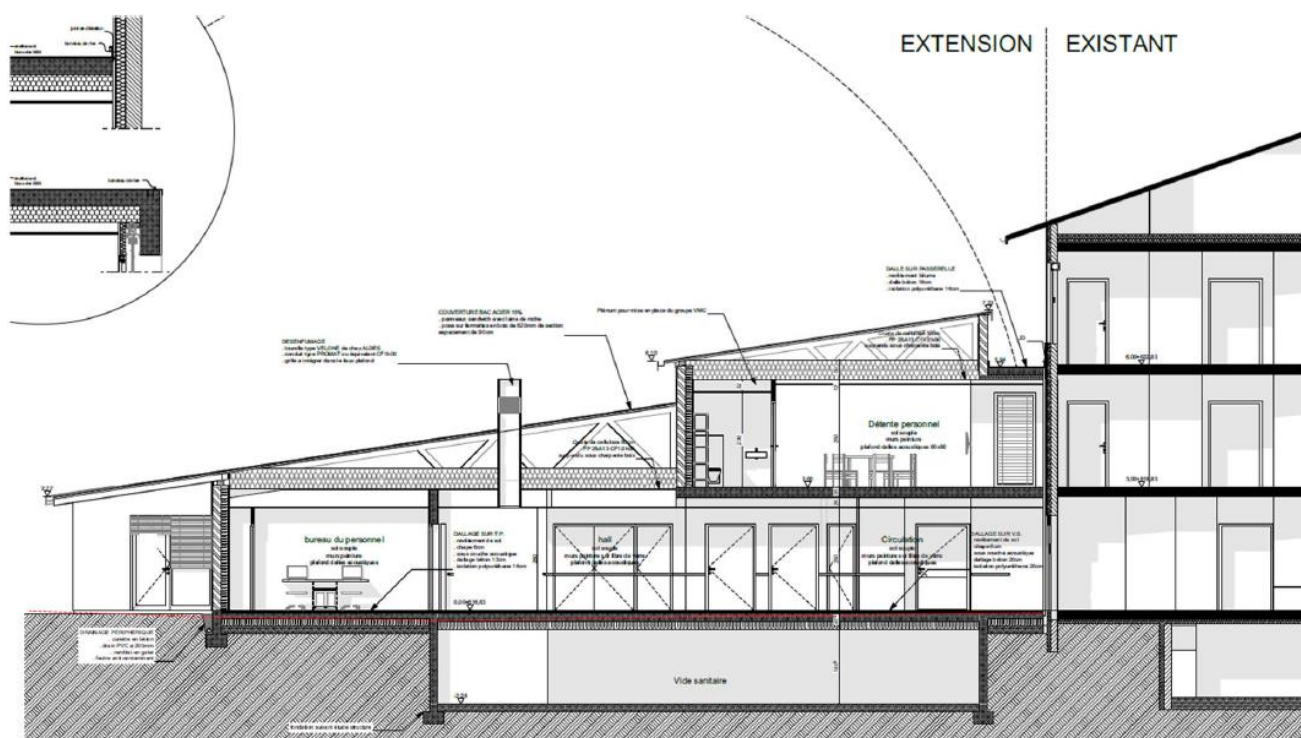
Extrait de coupe du bâtiment projeté - CETEL
